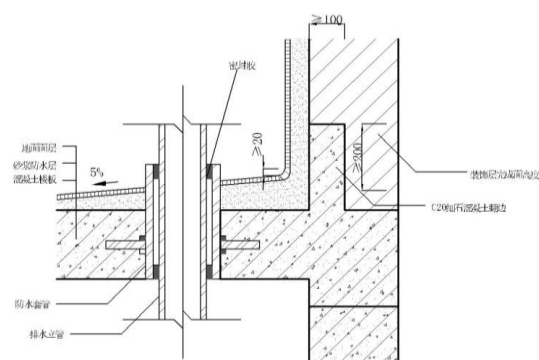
管道穿越楼板的高性能抗裂防水砂浆防水构造
